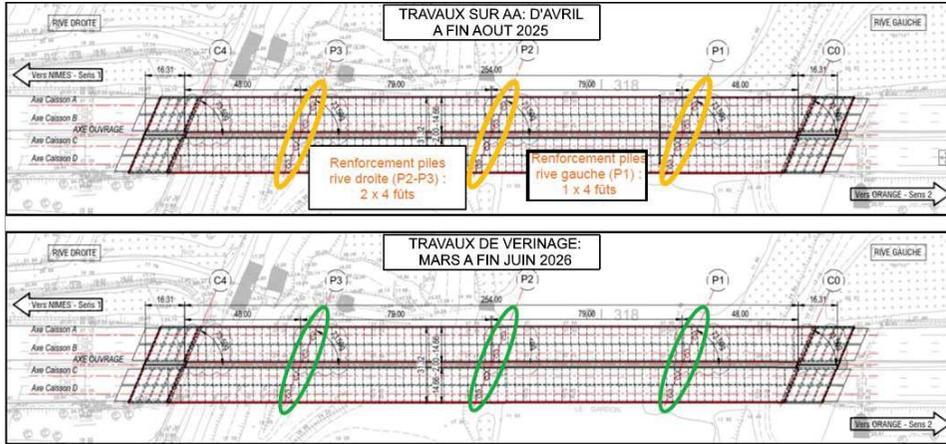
Extraits du plan de renforcement en têtes de piles (source : Arcadis MOE PRO)
